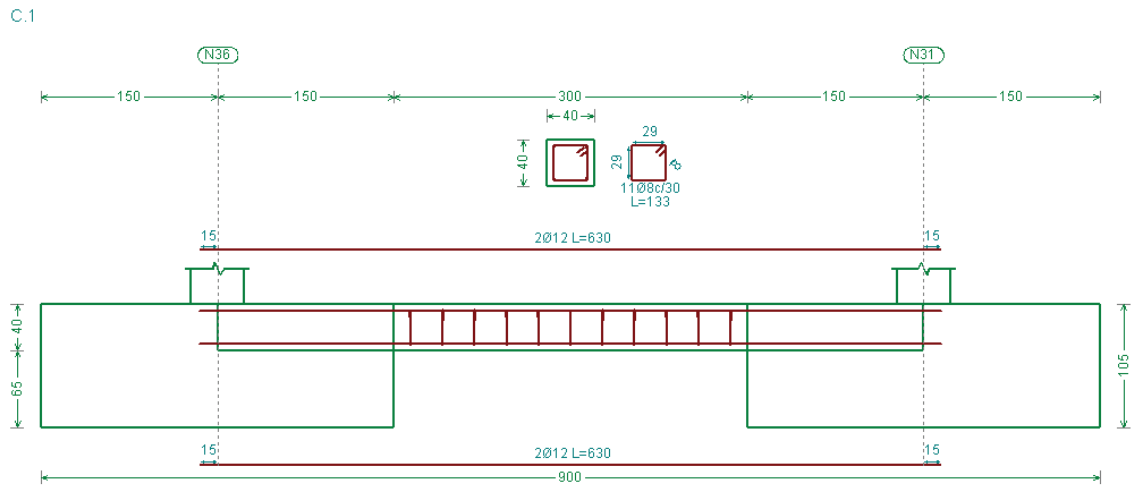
Armado viga riostra zapata tipo-zapata tipo.
